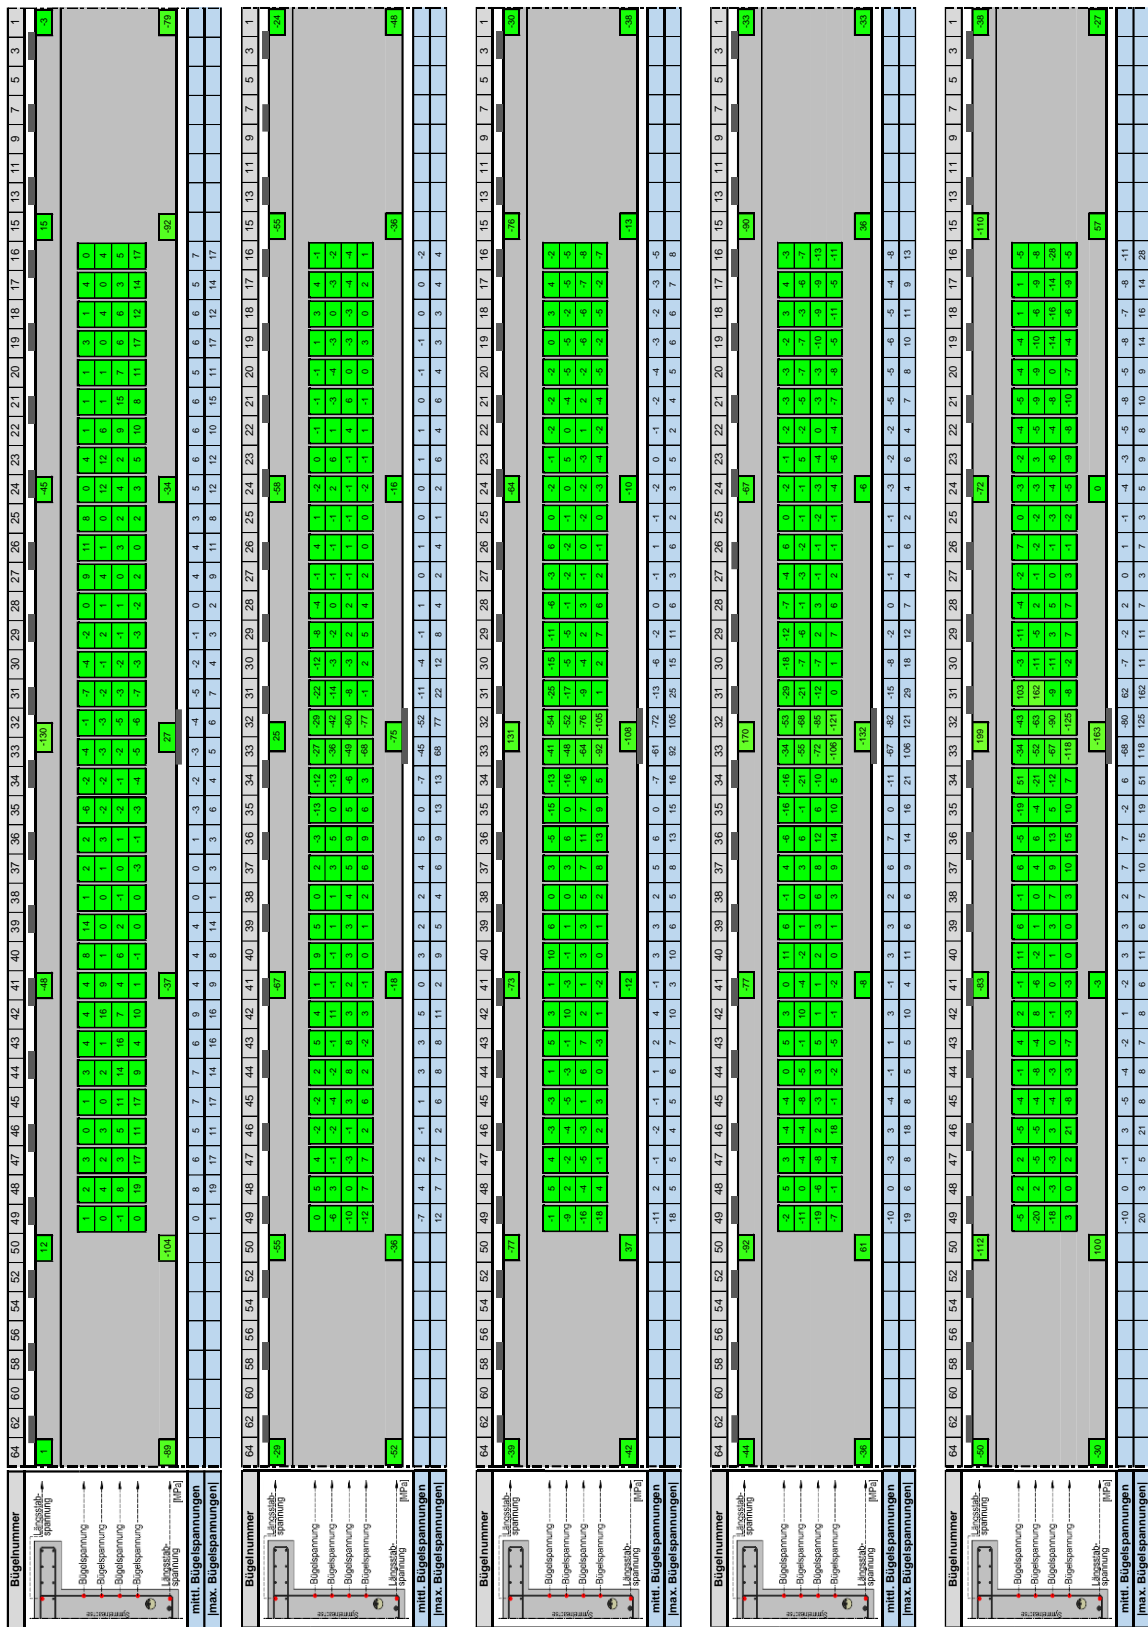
Betonstahlspannungen des Versuchsträgers DLT 3 für ausgewählte Laststufen, Teil 2
